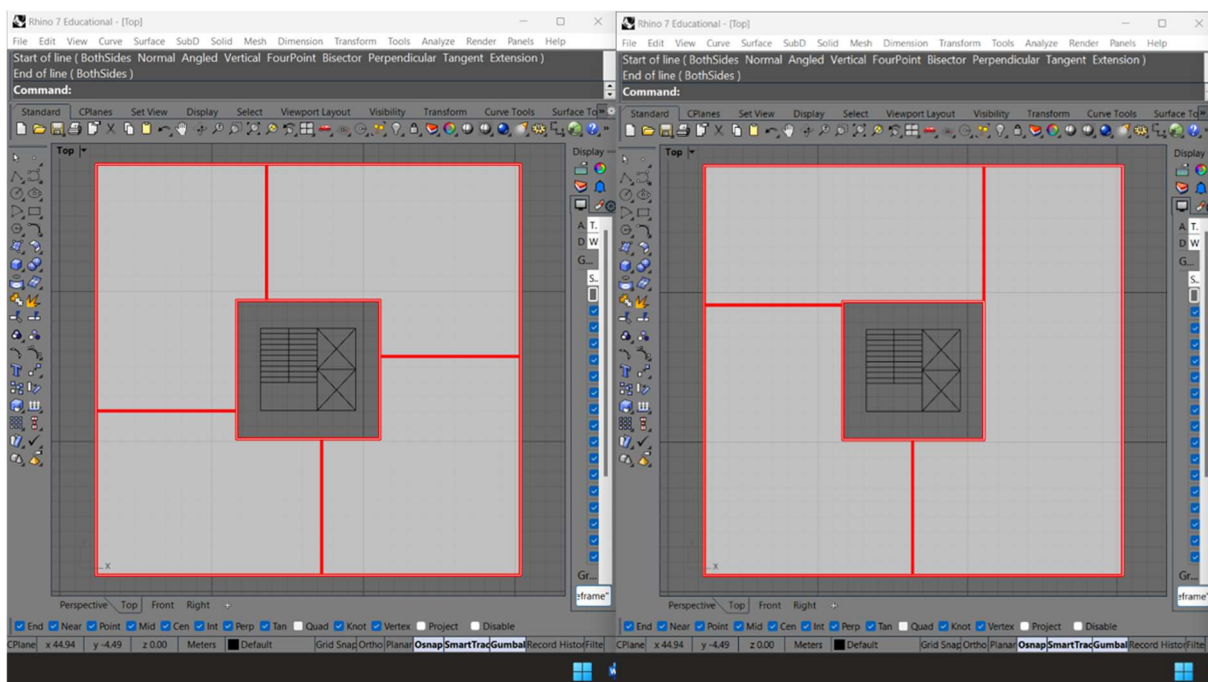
Dois exemplos de possíveis soluções para um pavimento do edifício, levando em conta as decisões tomadas nas etapas anteriores. Fonte: captura de tela do autor
